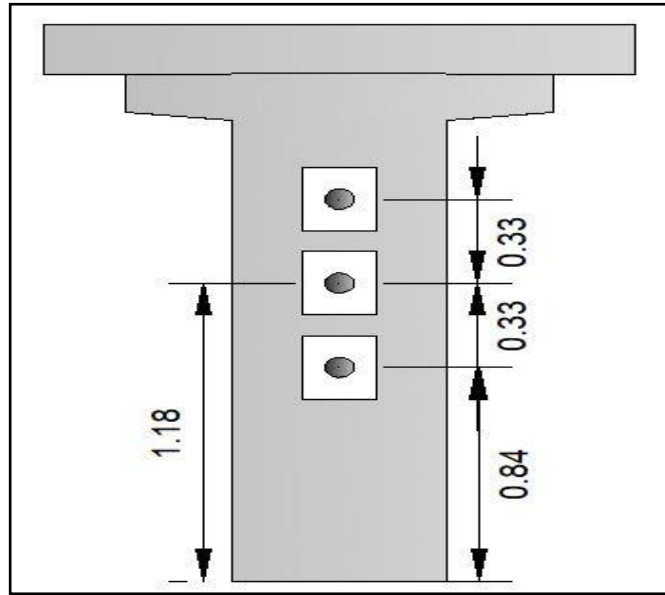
disposition des plaques d’ancrage et les câbles dans l’about
